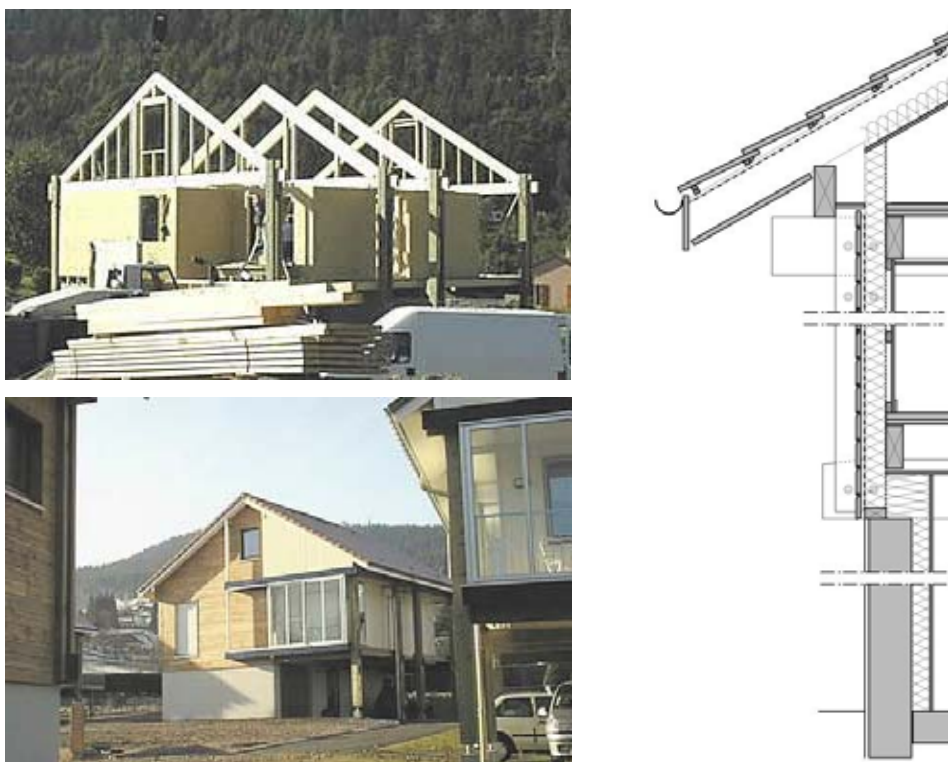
Execução, obra acabada e detalhe construtivo de habitação com solução construtiva em vigas biapoiadas. Fonte: BOIS-CONSTRUCTION (2007).
